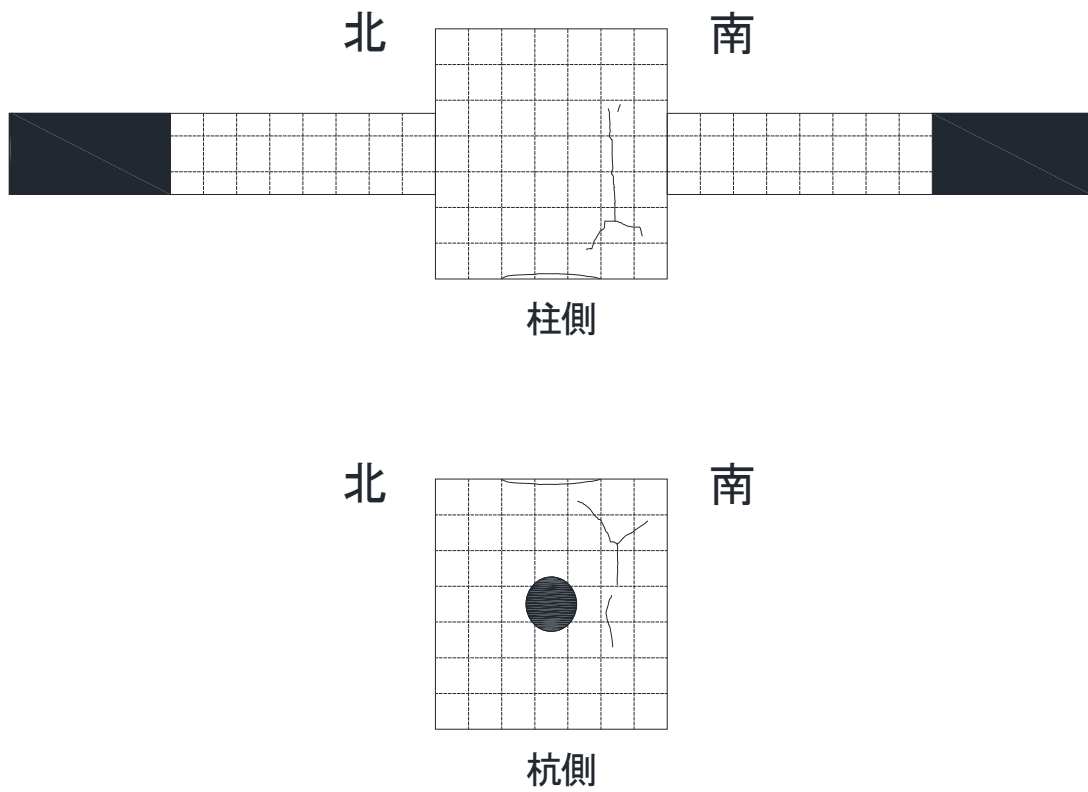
2. 4-37 試験体 DR-4 切断ひび割れ状況
